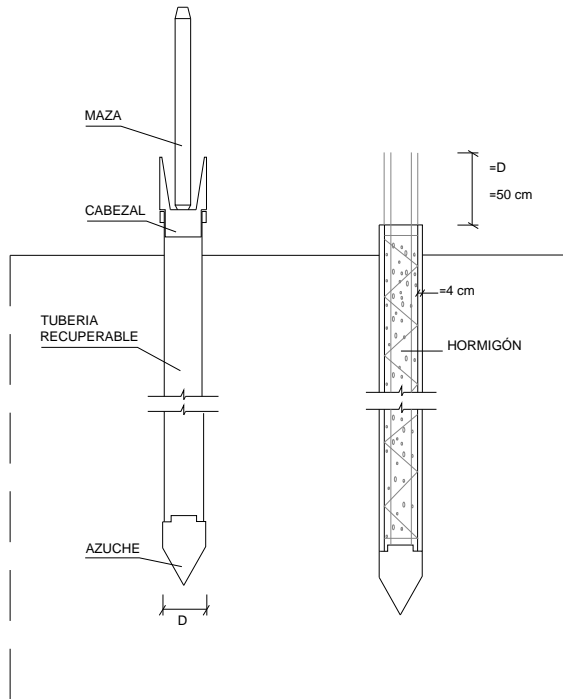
Pilote "in situ" con desplazamiento de azuche.¹¹
